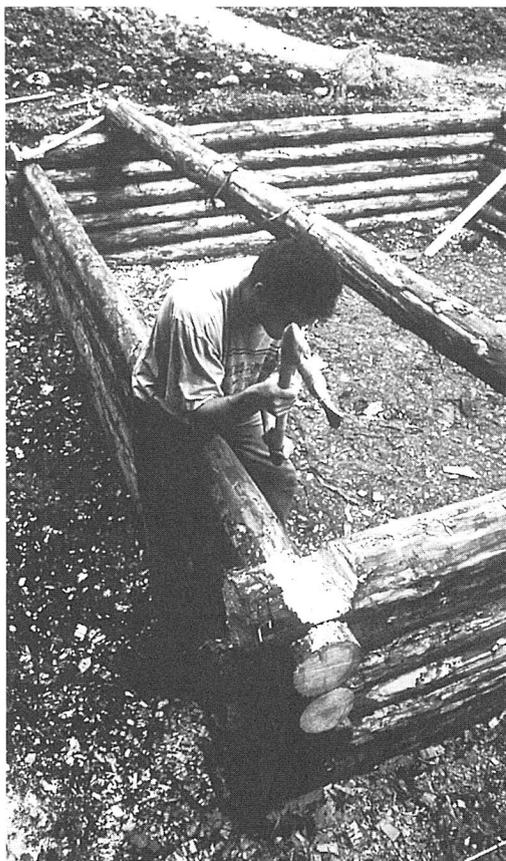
Aufzimmern der Blockwände mit Lappen- und Tüllenbeilen.
